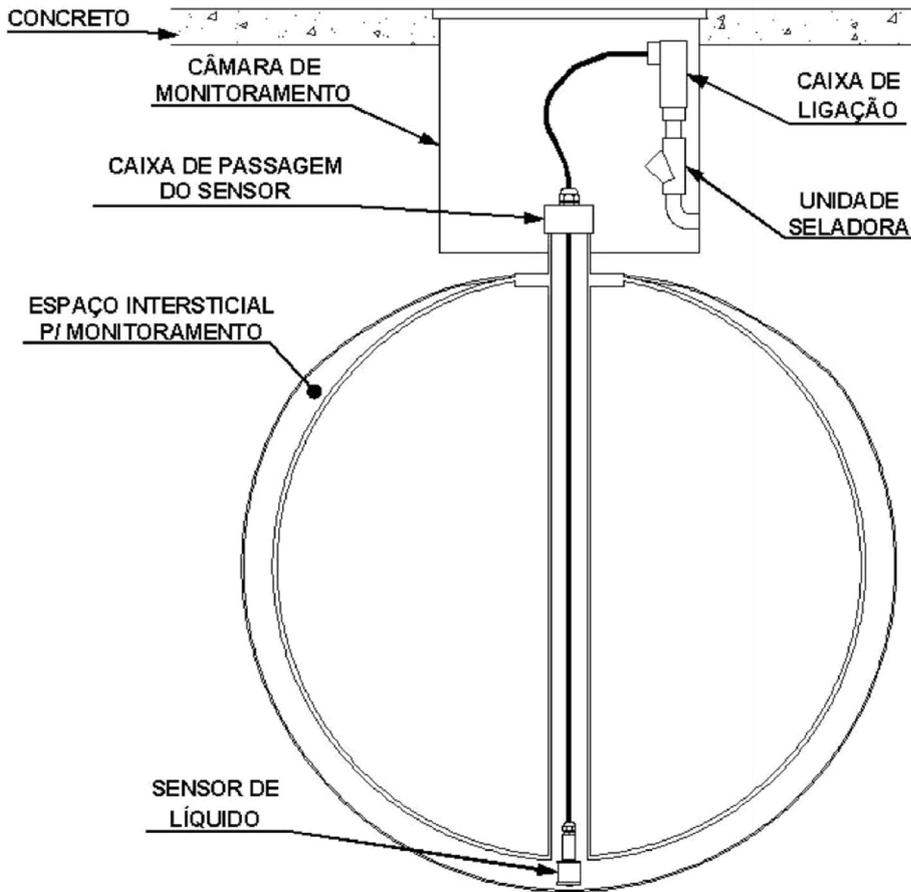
Instalação do sensor SmartLiq no tanque de combustível
